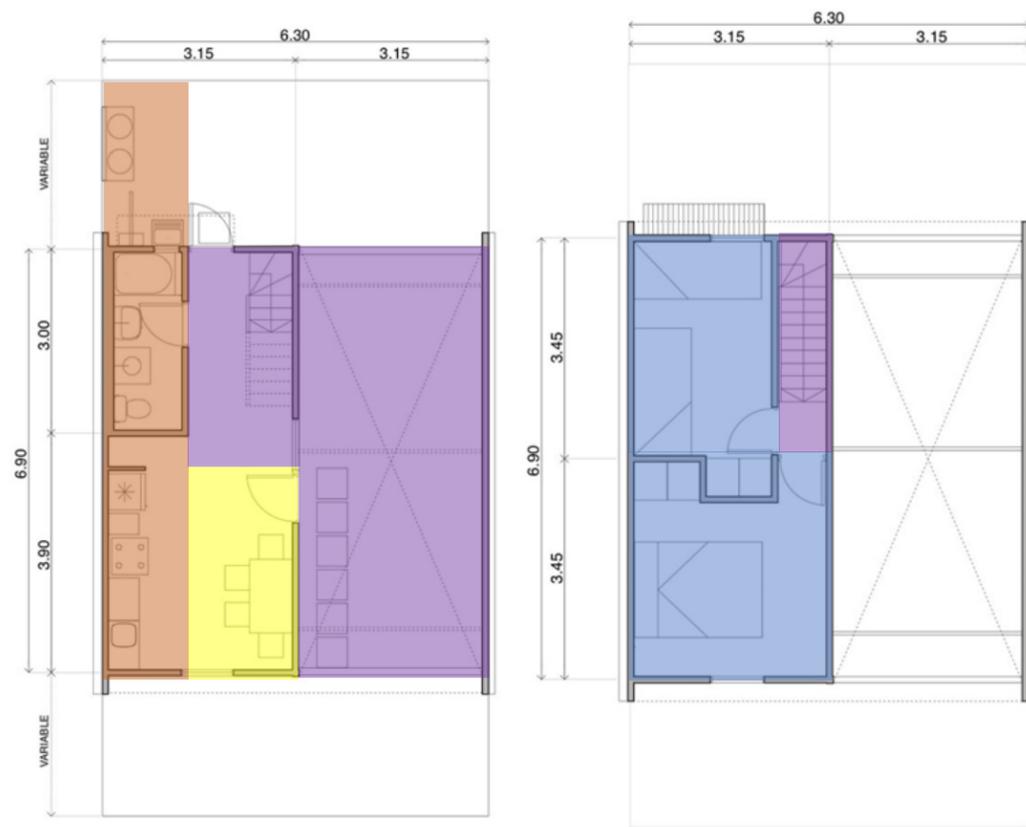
Planta Arquitectónica inicial primer y segundo nivel
